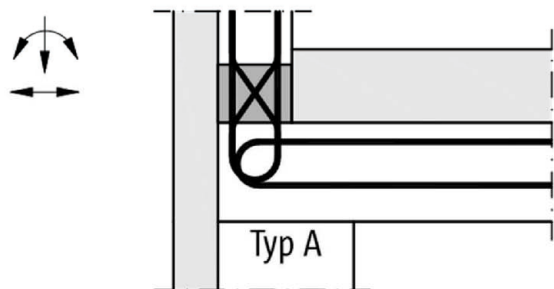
Schöck Isokorb® Typ H, Ergänzung für Horizontallasten senkrecht und parallel zur Dämmfuge
